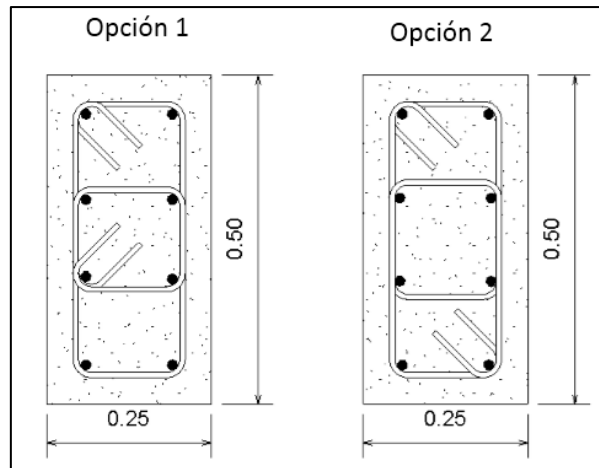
Diseño del acero en la columna de sección 0.25x0.50
